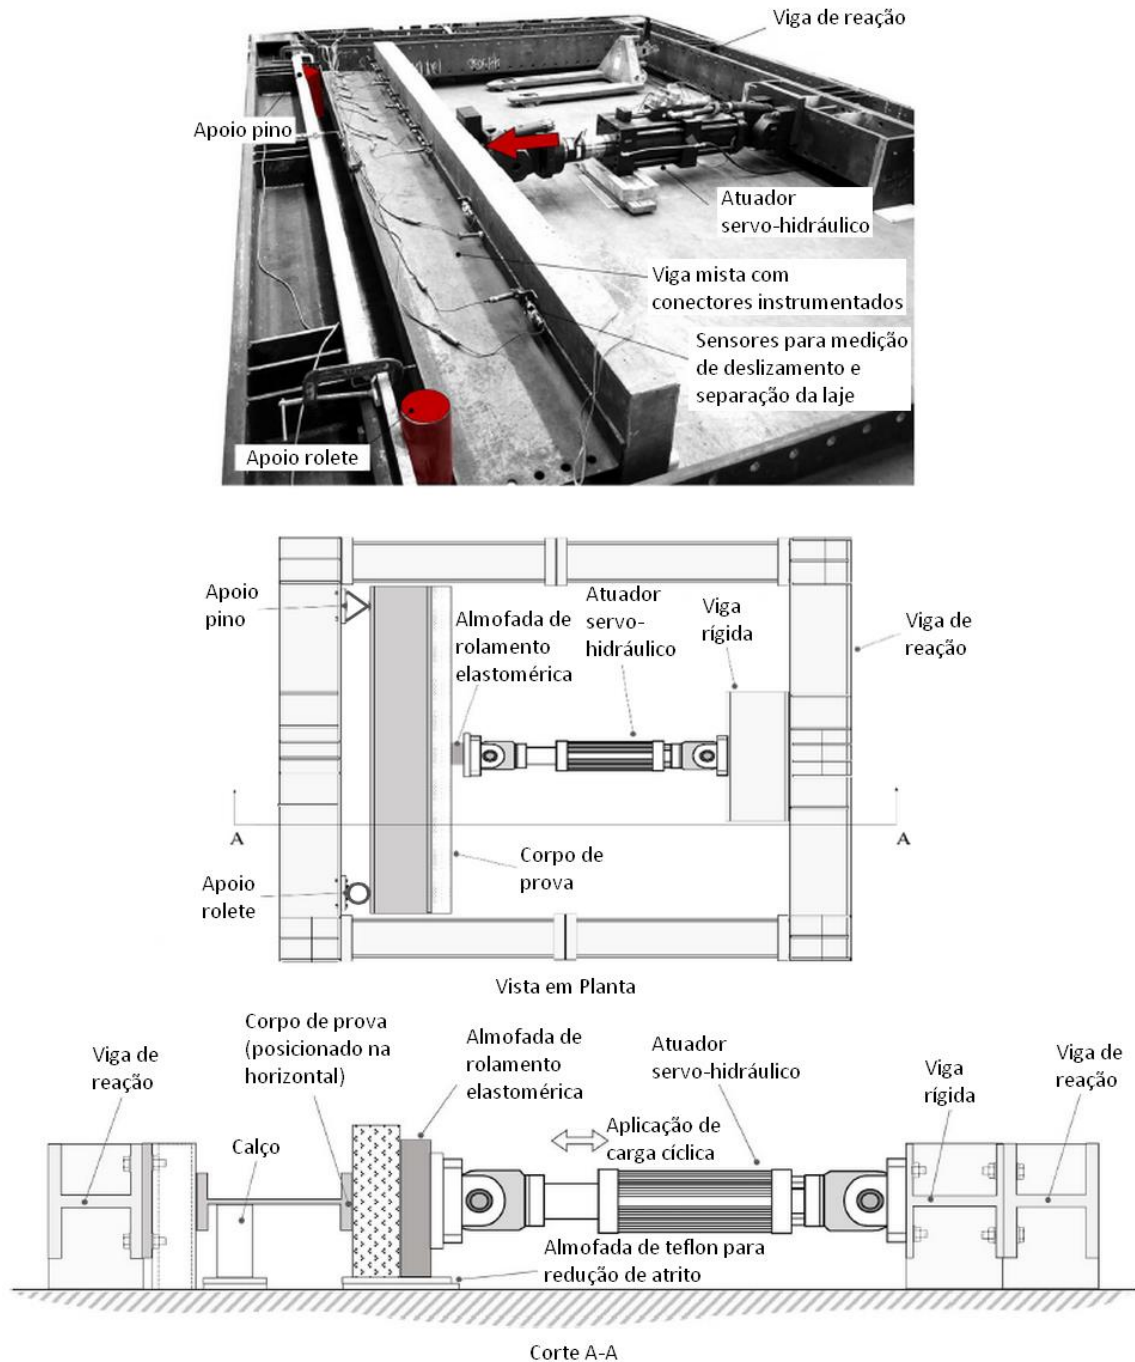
Instrumentação dos conectores, da laje e do perfil componentes da viga mista ensaiada por Hillhouse e Prinz (2020)
